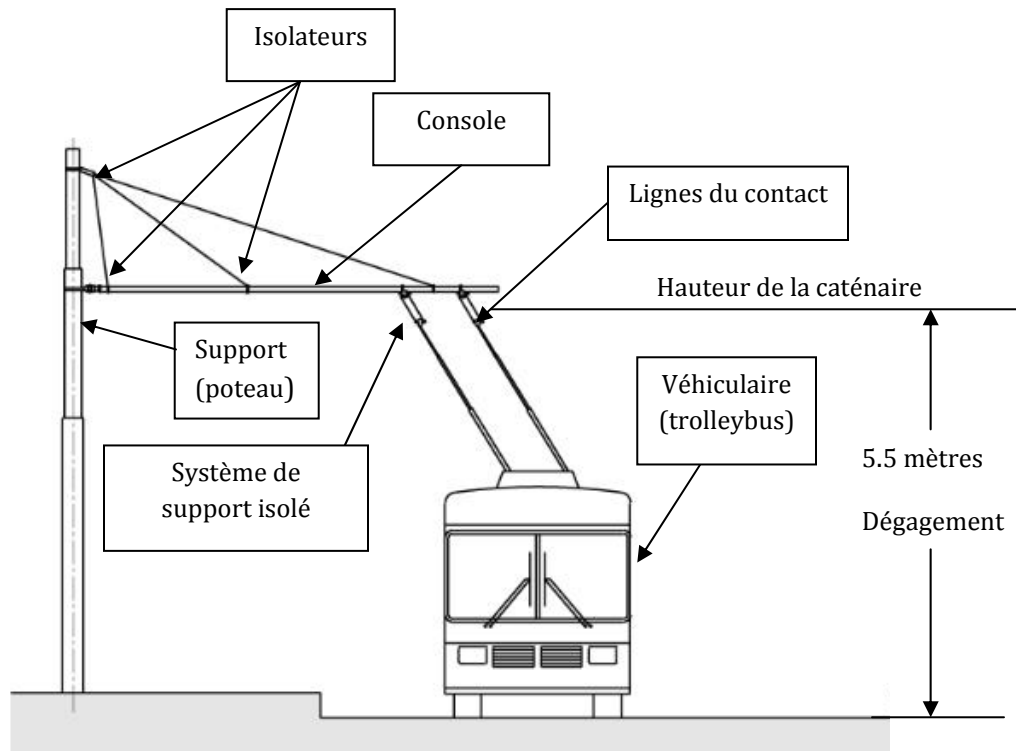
INSTALLATION D'UNE CATÉNAIRE AVEC UN SYSTÈME DE CONSOLE ET UN POTEAU
